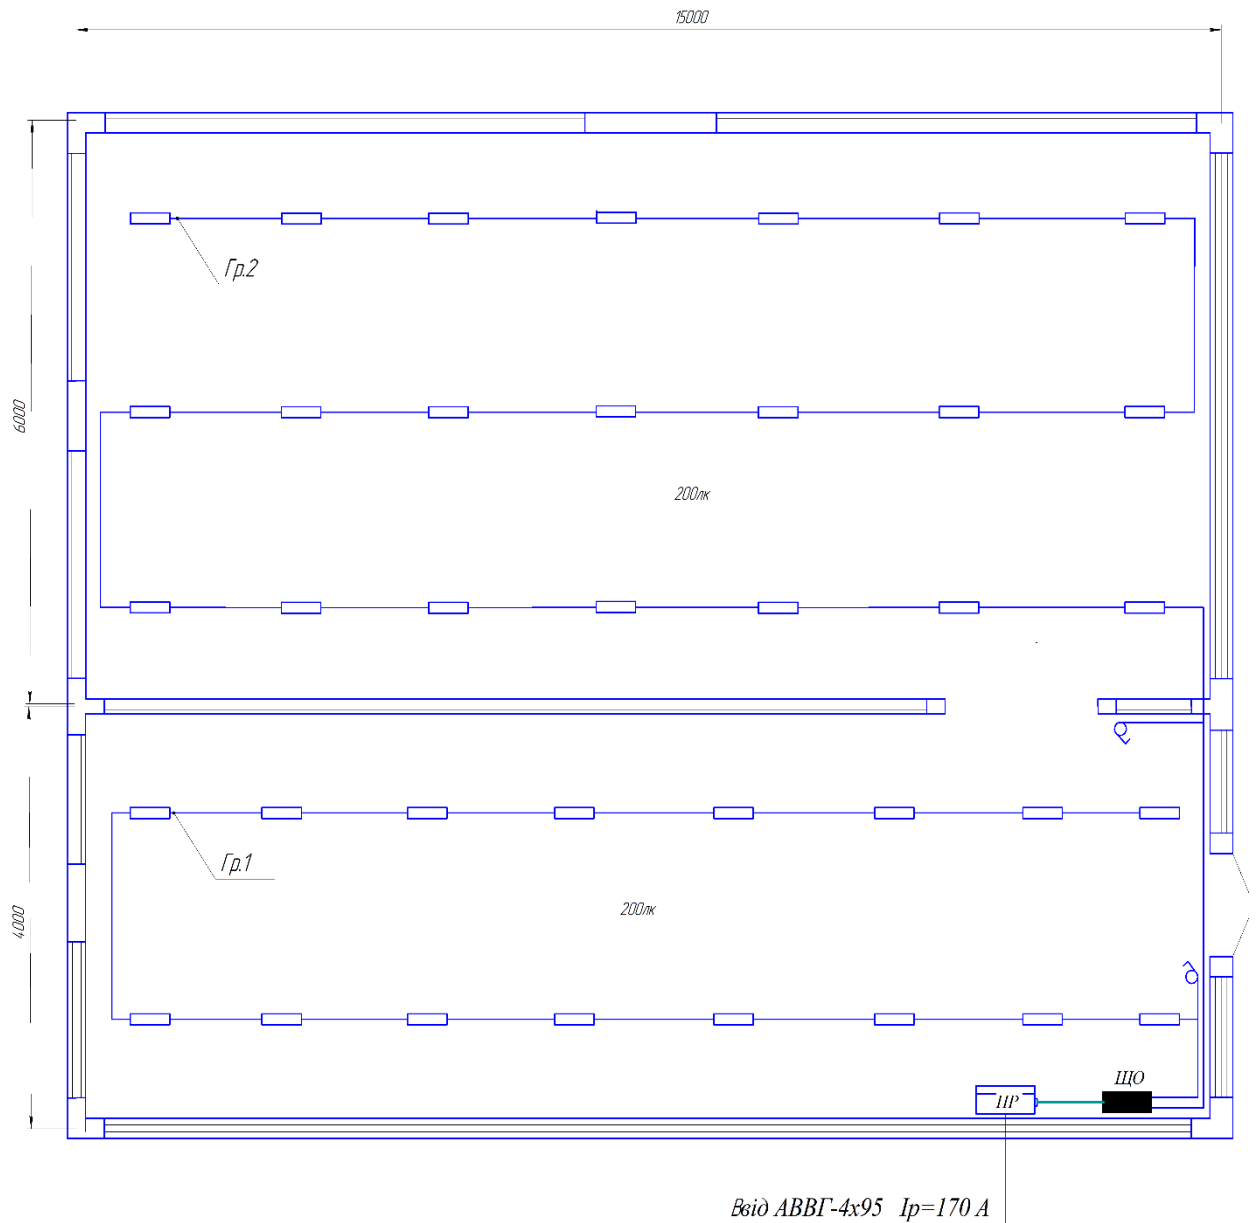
План силової майстерні з нанесення освітлювальної проводки для ККЛ.
